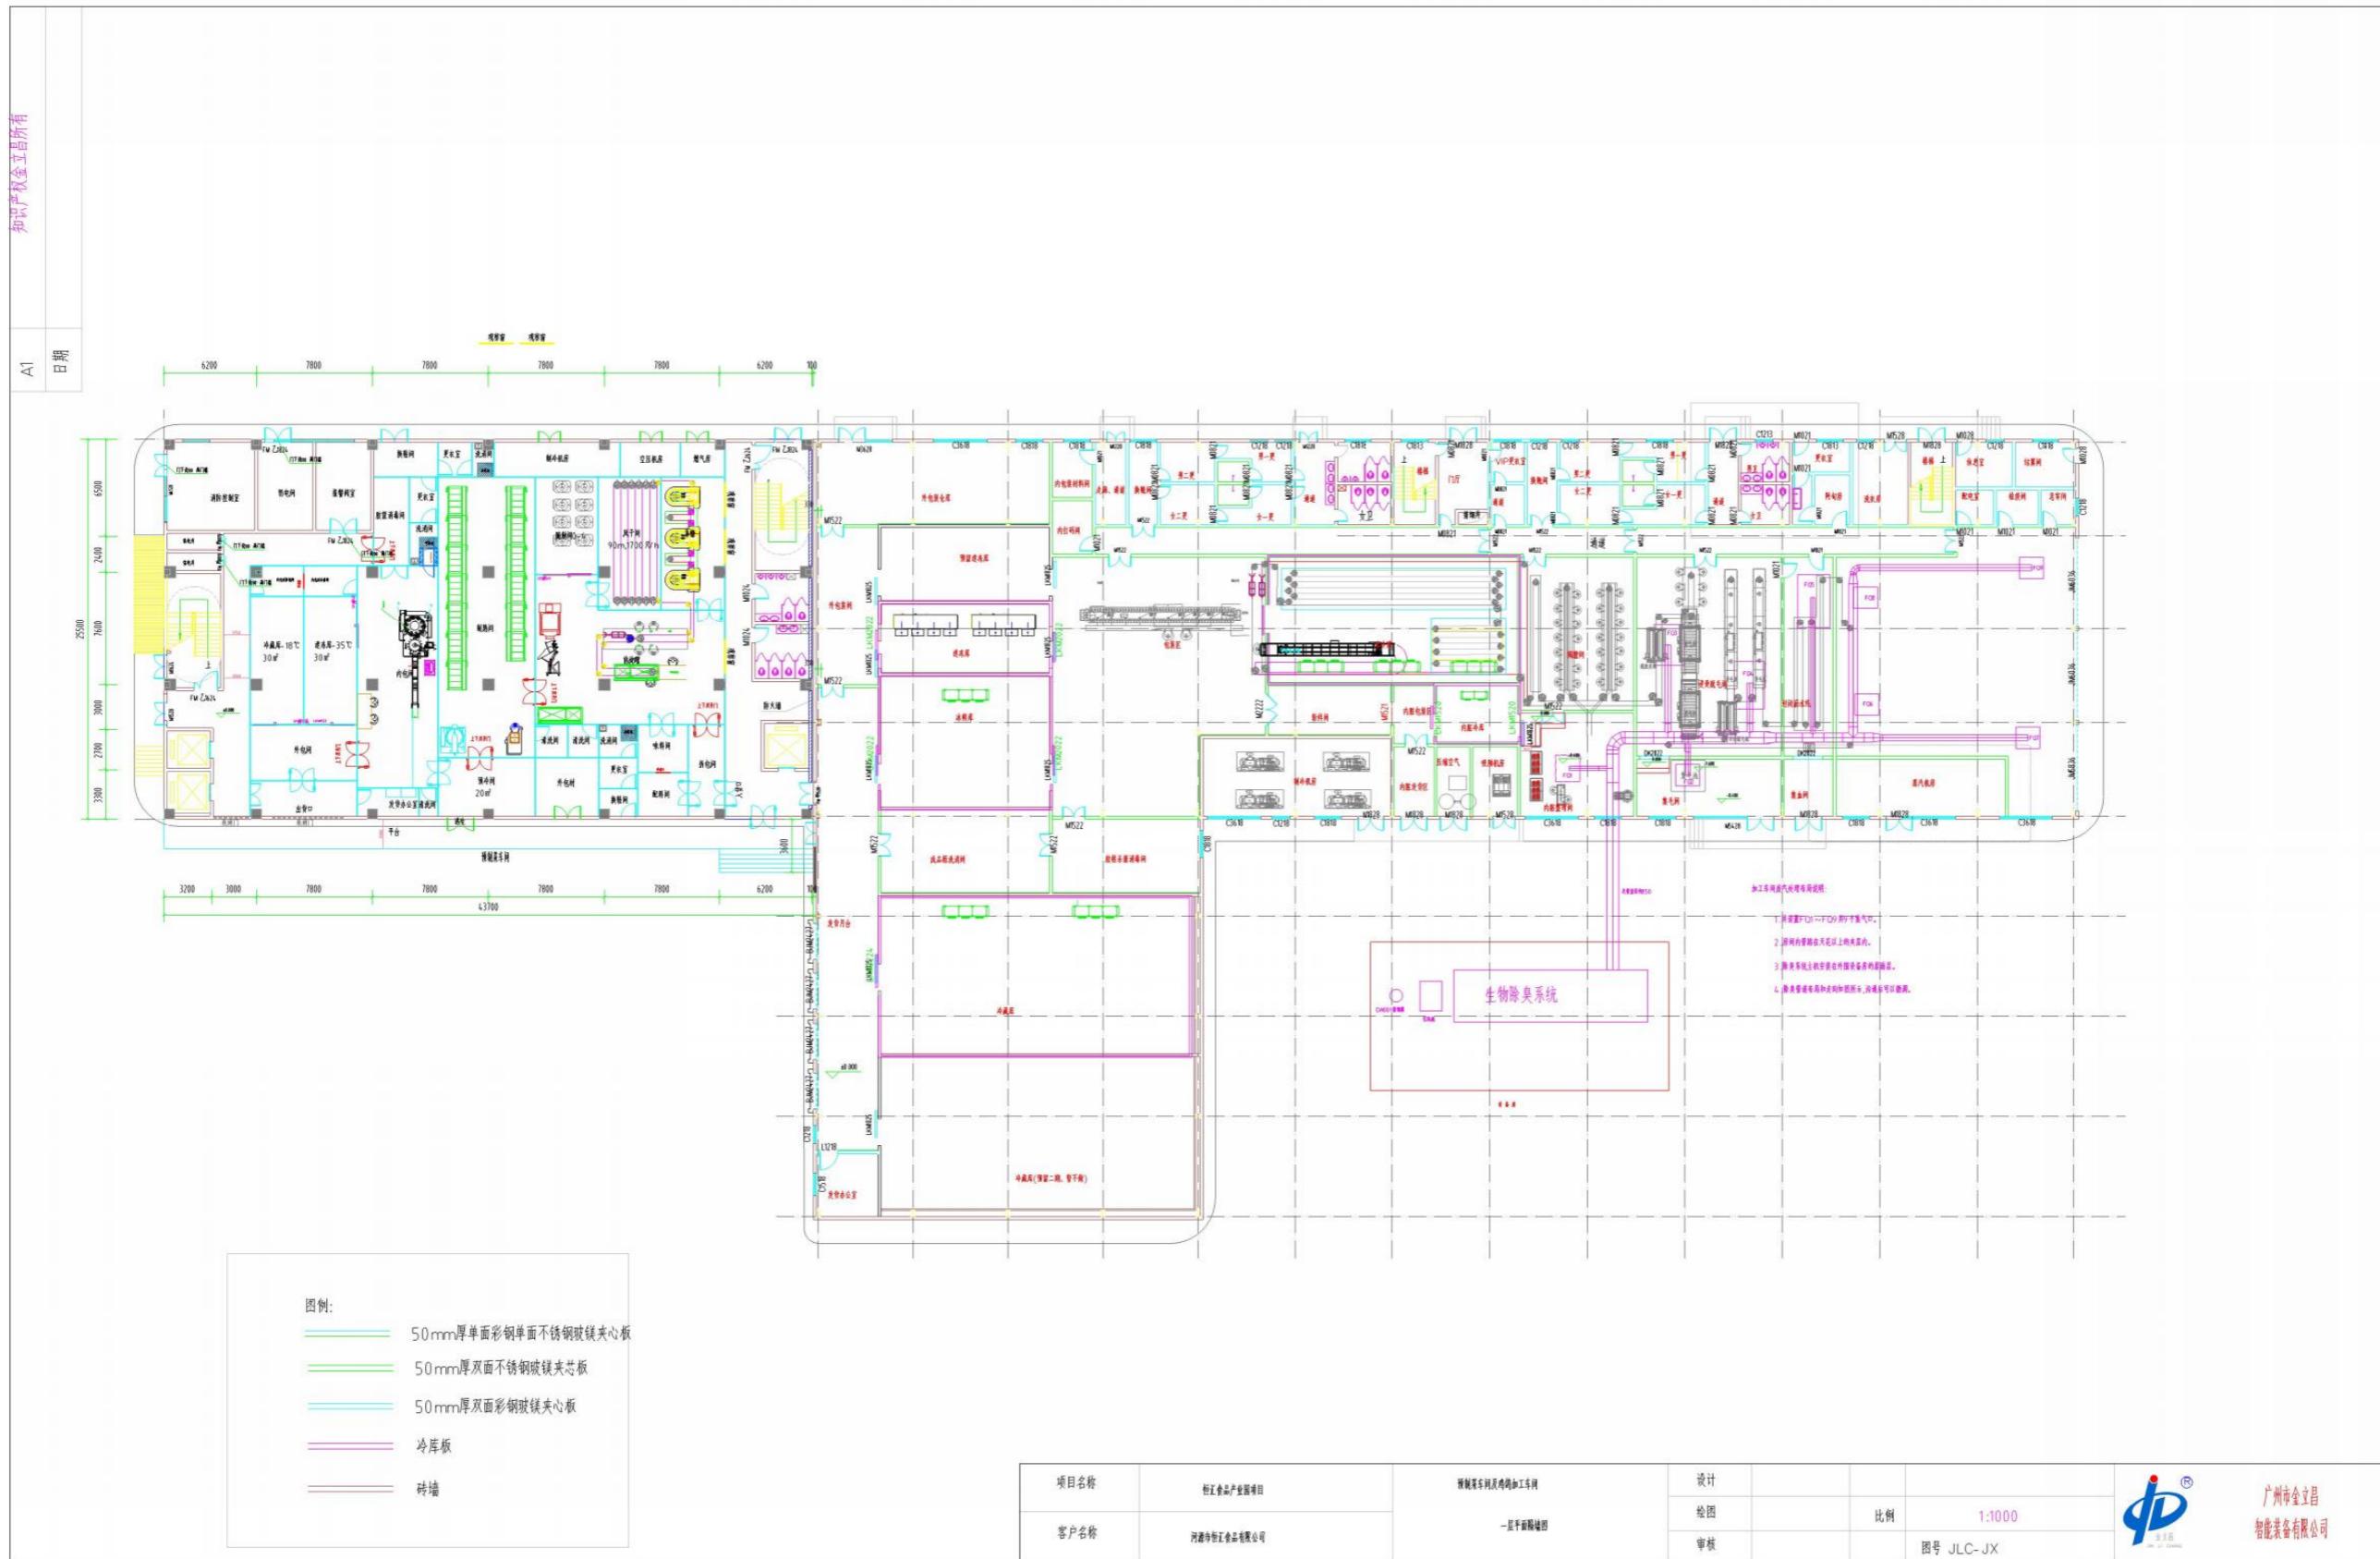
本项目预制菜车间及鸡鸽加工车间（含冷冻库）平面布置图
